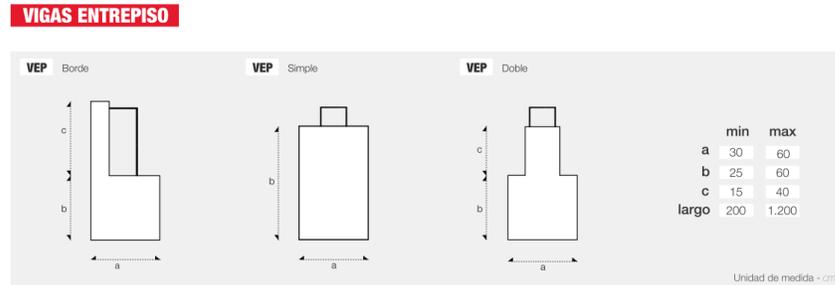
Tipos y dimensiones de vigas prefabricadas de hormigón
